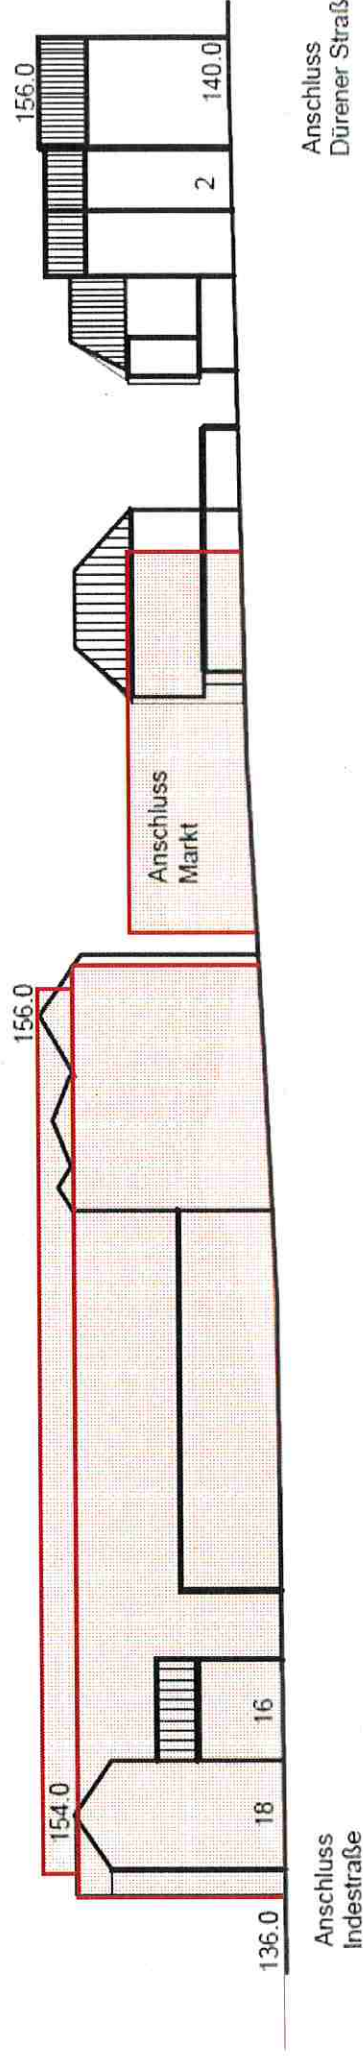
Schematische Fassadenabwicklung Wollenweberstr./Westseite, Höhenangaben näherungsweise in m ü NHN [Quelle: Stadt Eschweiler]
